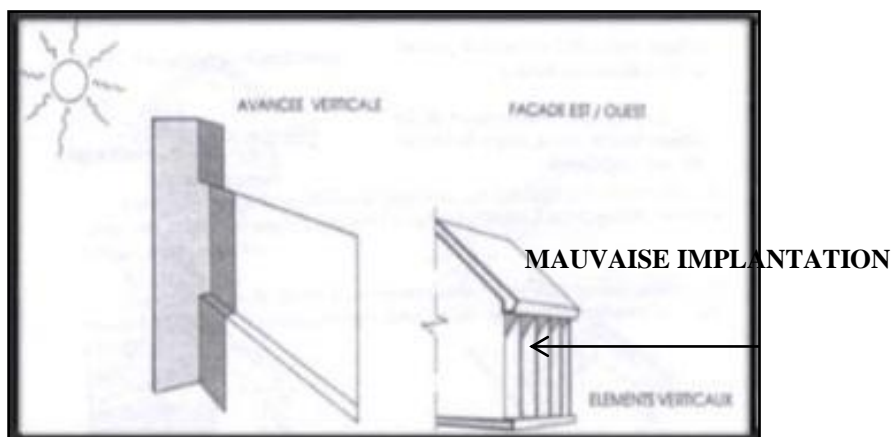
AVANCEE VERTICALE - Façade EST/OUEST
